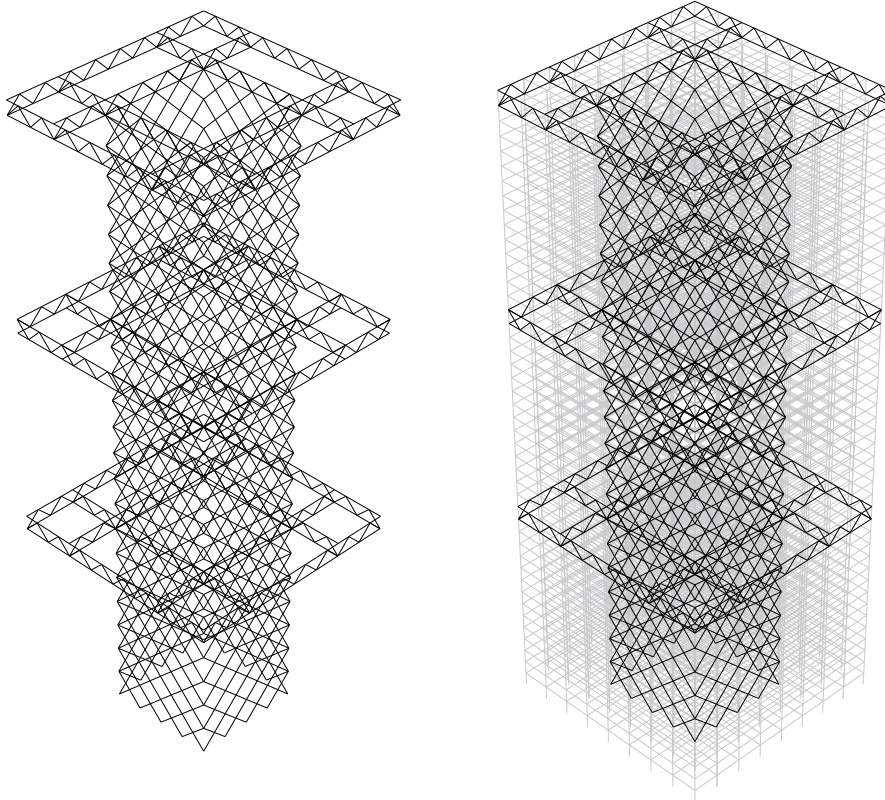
rappresentazione schematica della struttura tridimensionale dell'Edificio 3.
